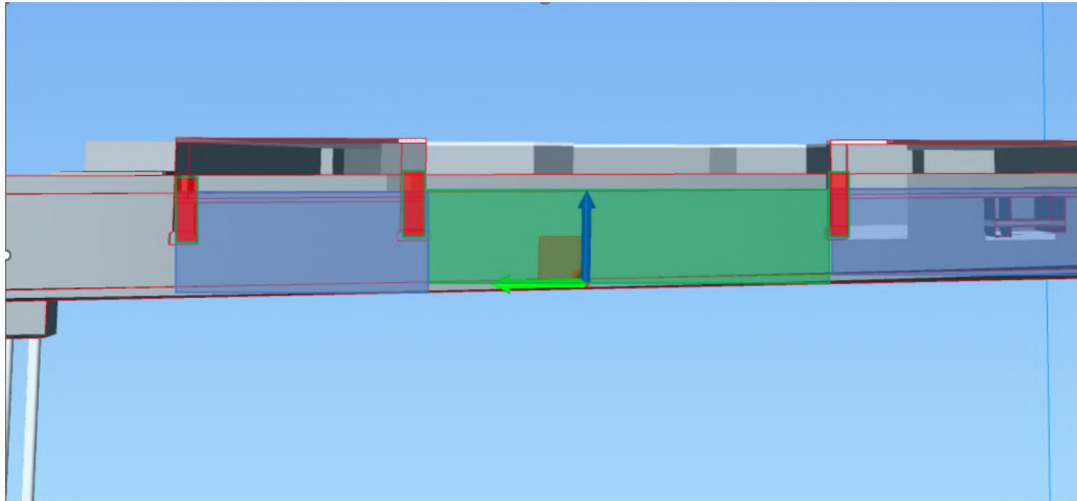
Schnitt A – A Westwand Tunnel (Nora)
